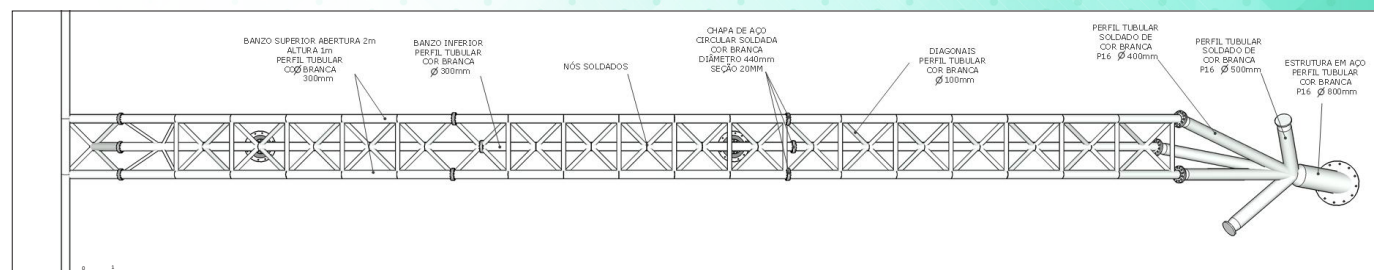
Detalhamento treliça 03. Vista superior. Planta técnica anexa em escala 1:100. Rafael Rodamilans, 2018
